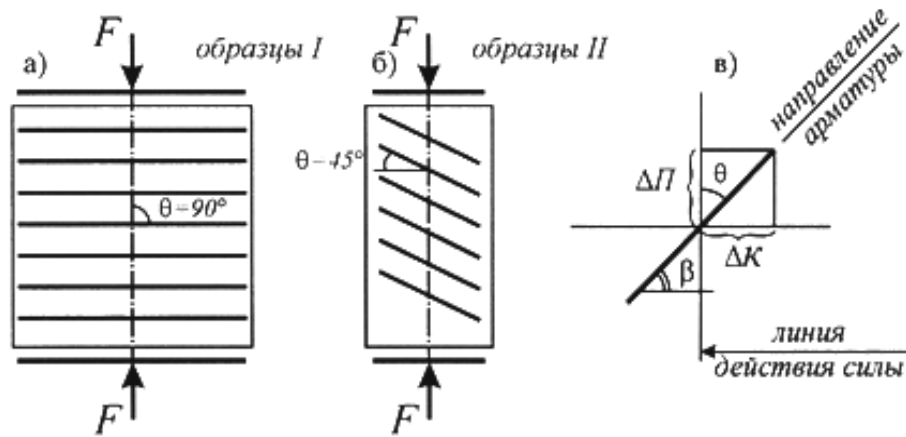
Схема армирования бетонных образцов, испытанных в работе Робинсон:
